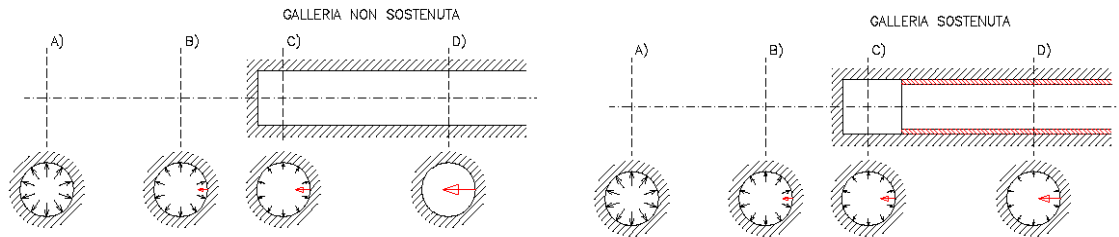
Progressivo di confinamento del bordo di scavo per simulare l'avanzamento della galleria
